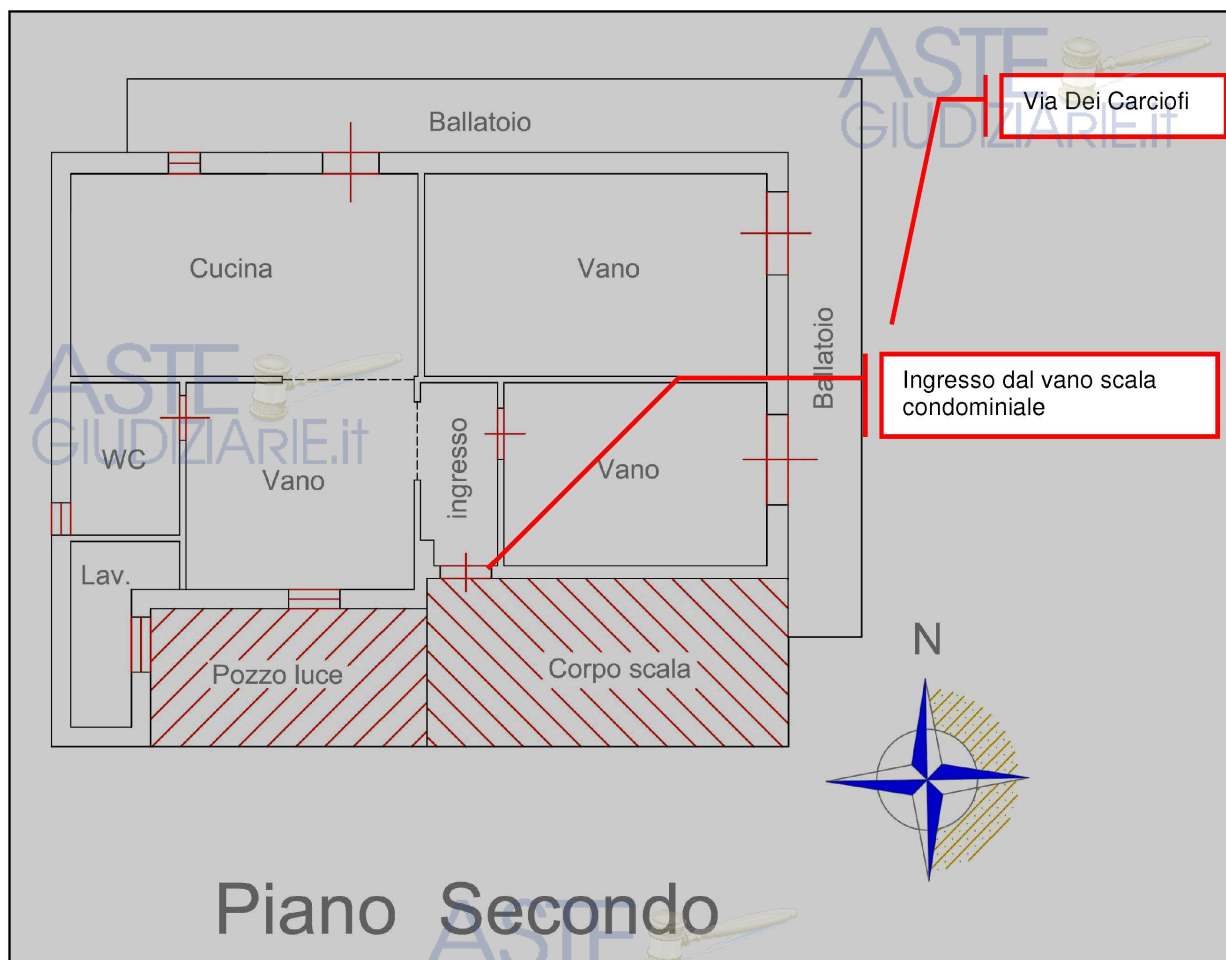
Visualizzazione della planimetria reale dei luoghi dell'appartamento a piano secondo
